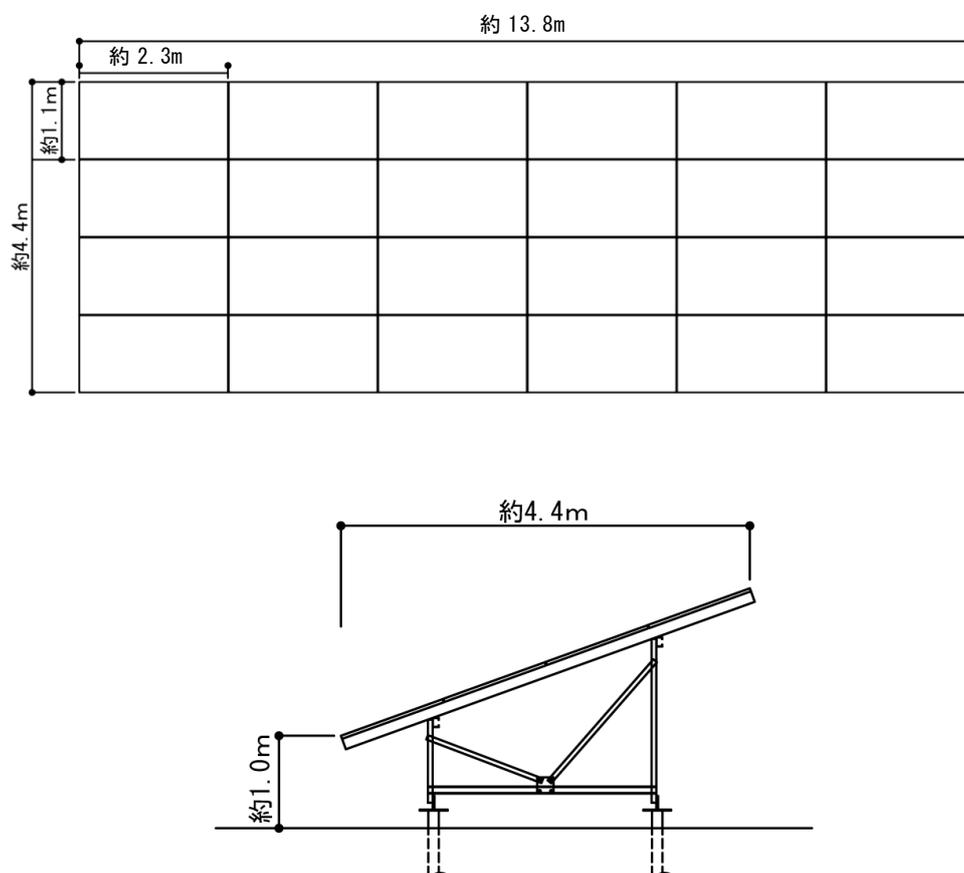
太陽光パネル（アレイ）平面図及び架台断面図（例）
